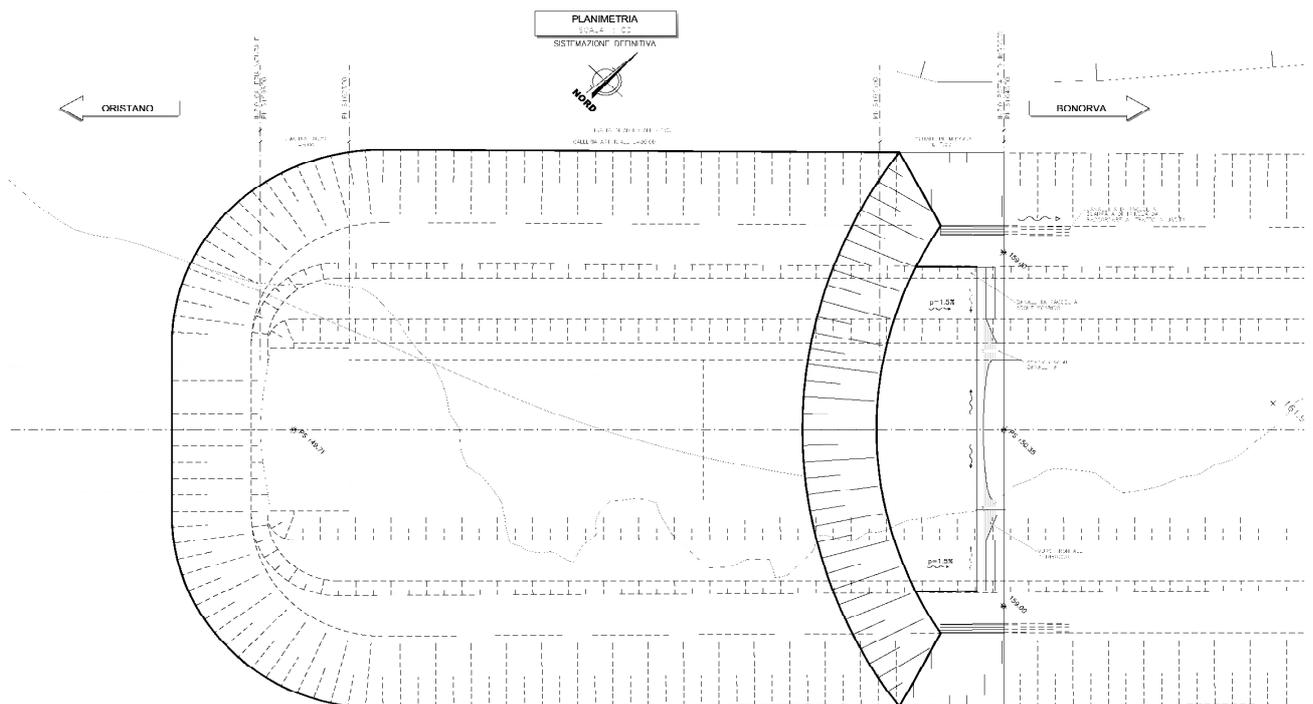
Planimetria di sistemazione definitiva Imbocco lato Bonorva galleria Bauladu
